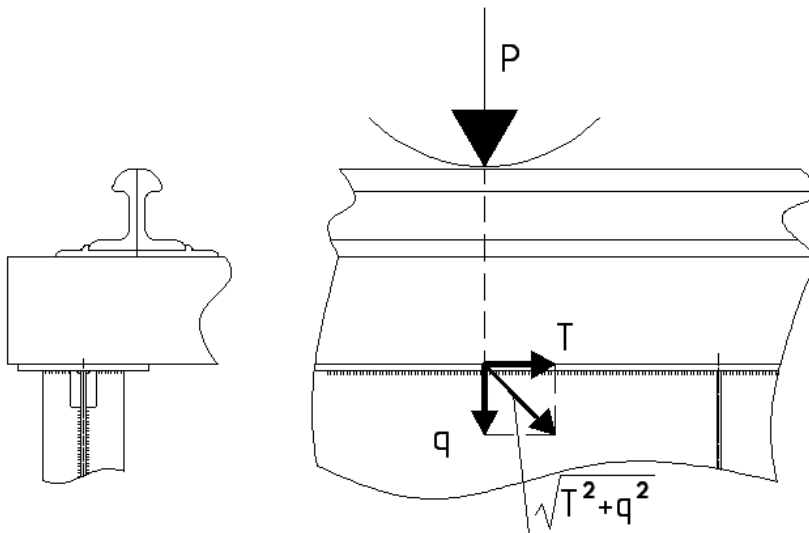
Поздовжня балка (поперечний переріз і фасад)
